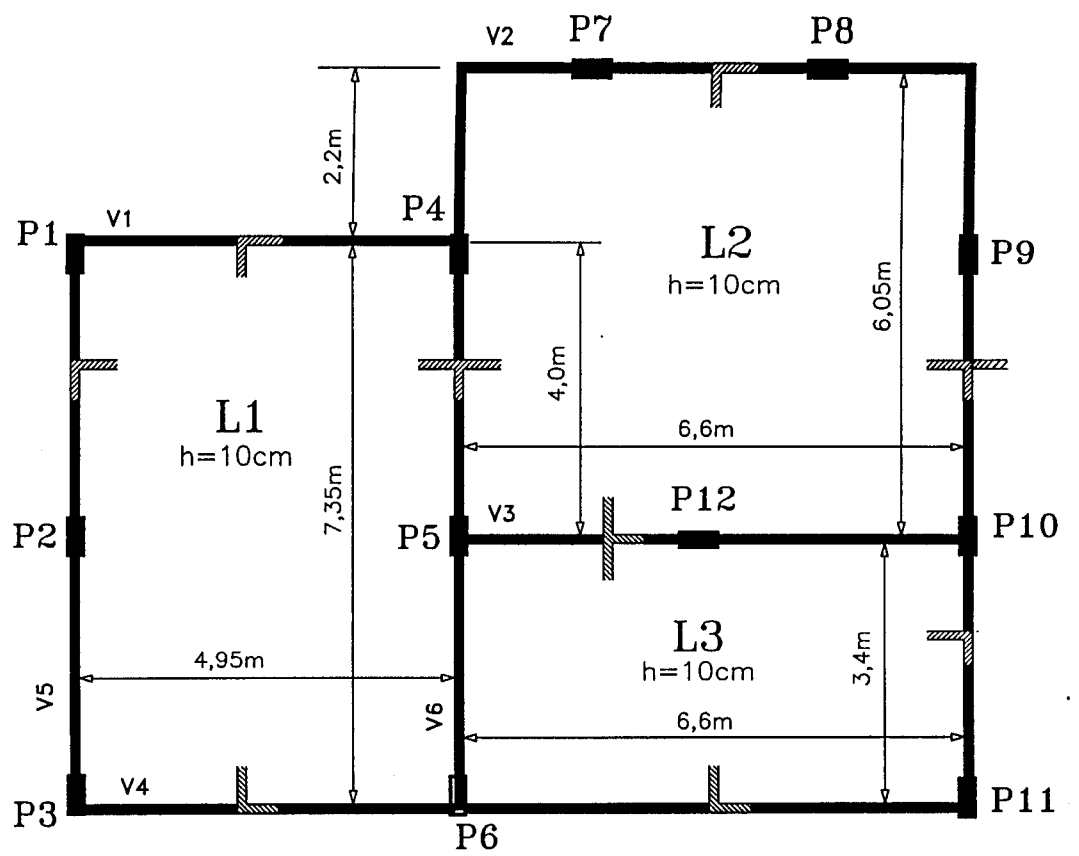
ESTRUTURA 2.2 - FORMAS - LAJE MACIÇA
